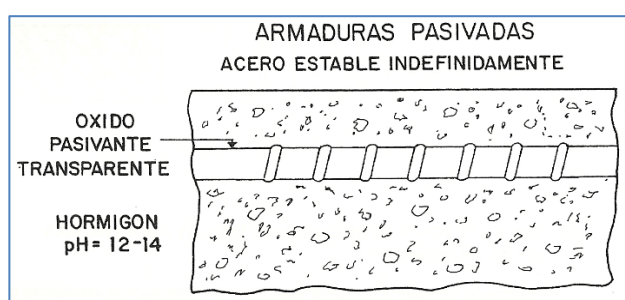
ARMADURAS EMBEBIDAS EN UN HORMIGON SIN CONTAMINAR.⁵
